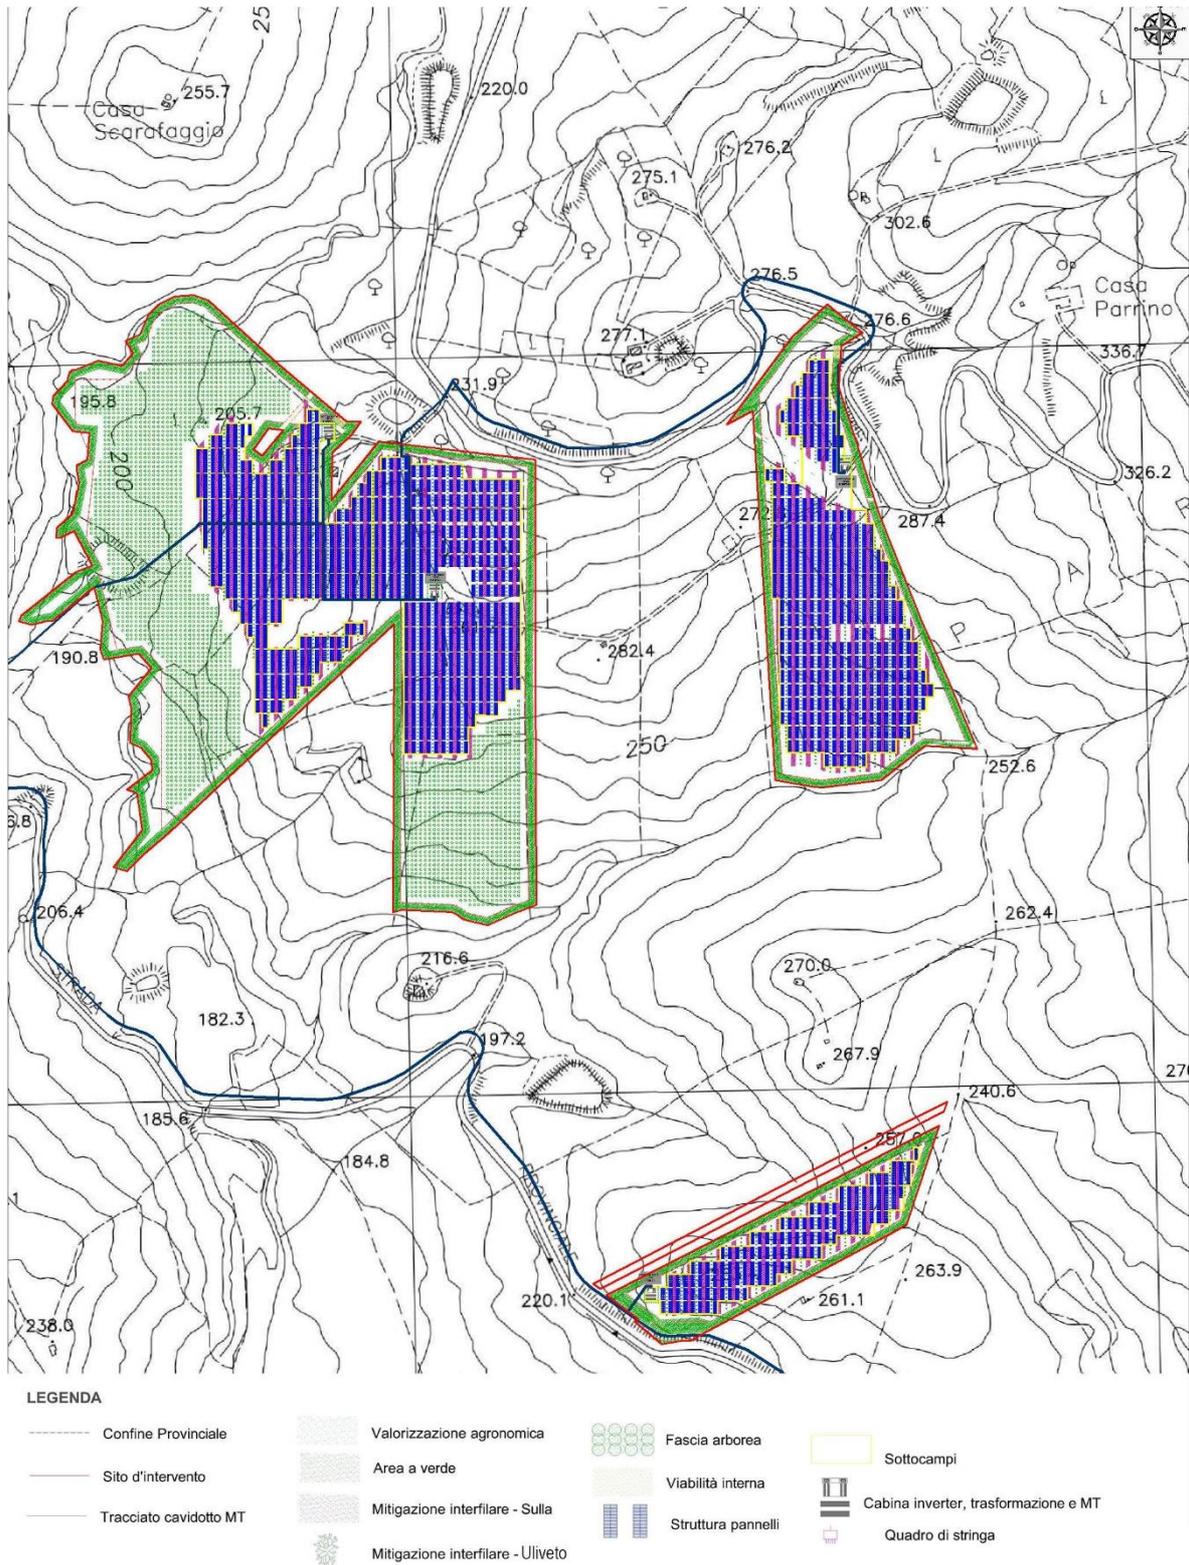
B – Layout dell'impianto ricadente in Contrada Parrino con cavidotto
